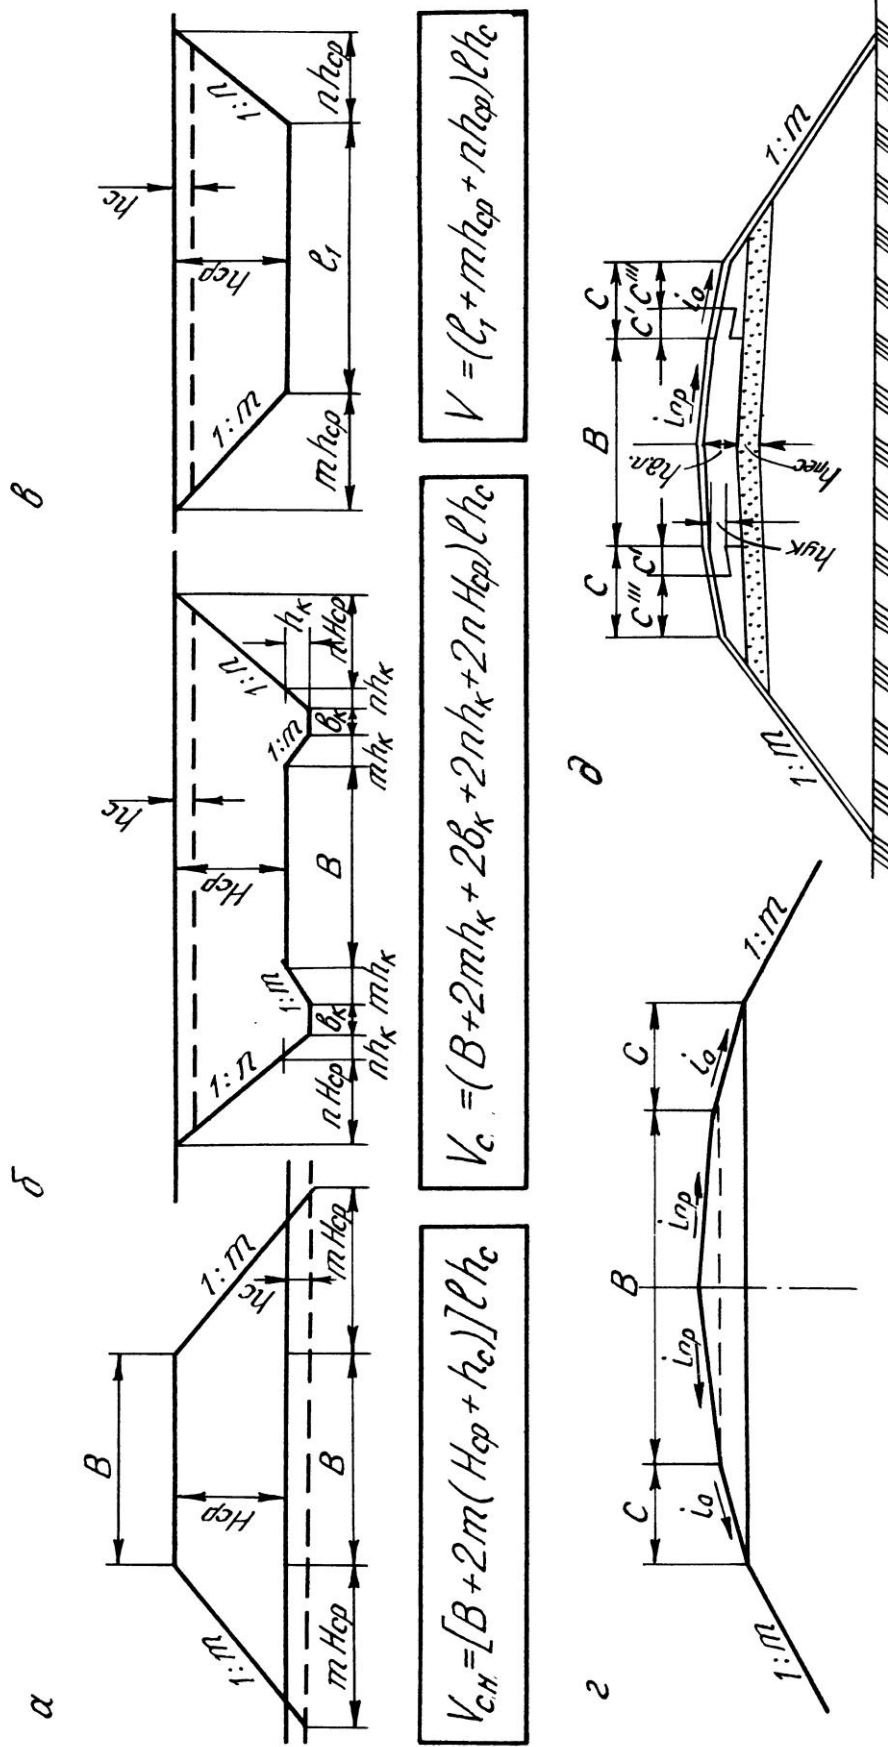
Расчетные схемы для определения объемов земляных работ: а – срезка грунта под насыпью; б – срезка грунта на выемке; в – срезка грунта на ширине резерва; г – параметры сточной призмы; д – параметры дорожной одежды
